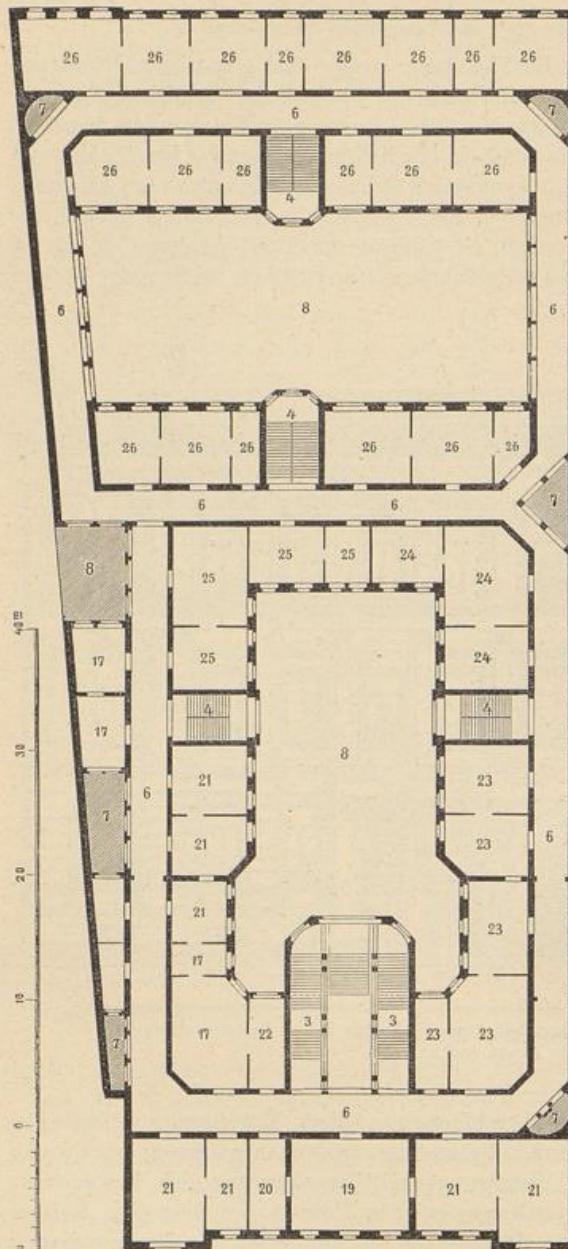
Gebäude des General-Postamts. (Grundriss des II. Stockwerks.)
